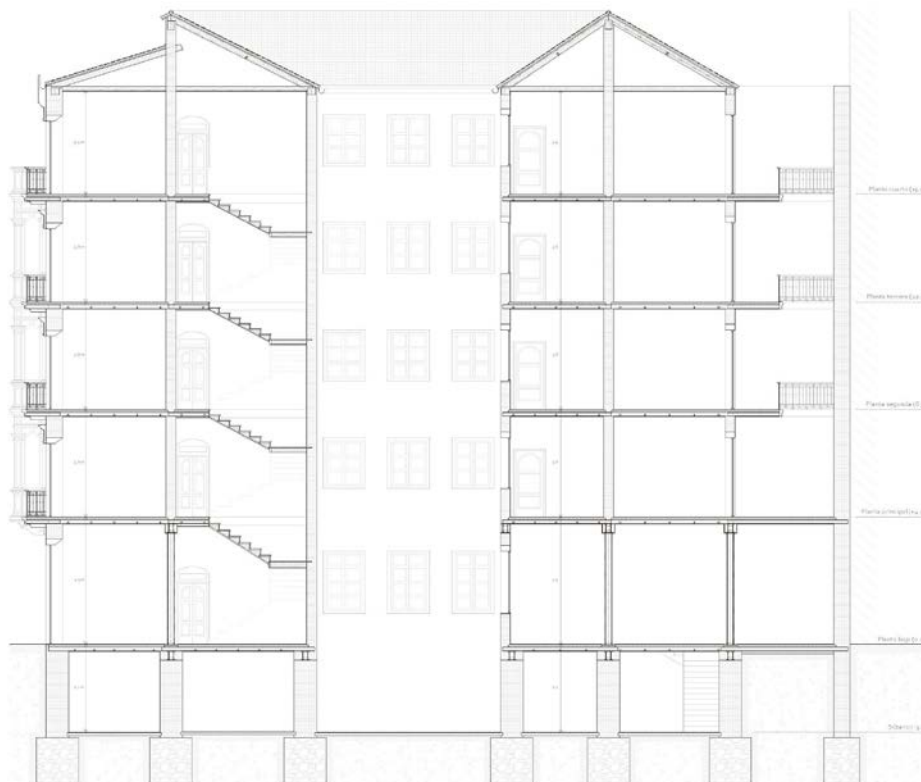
Reconstrucción gráfica de la sección constructiva del proyecto de en la calle Reyes Católicos 37 – actual 40–, redactado por José Felipe Giménez Lacal en noviembre de 1929. Fuente: elaboración propia a partir la reinterpretación de los planos originales (figura 1) y de la toma de datos in situ del edificio.
